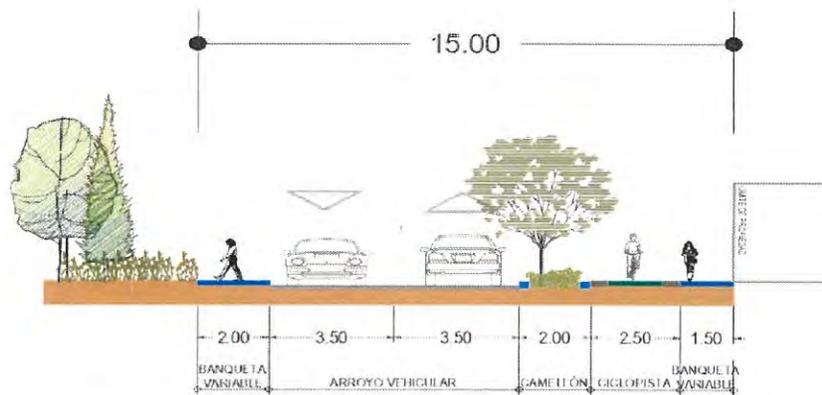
Sección transversal Av. Fernando Alencastre. Fuente: IDOM
